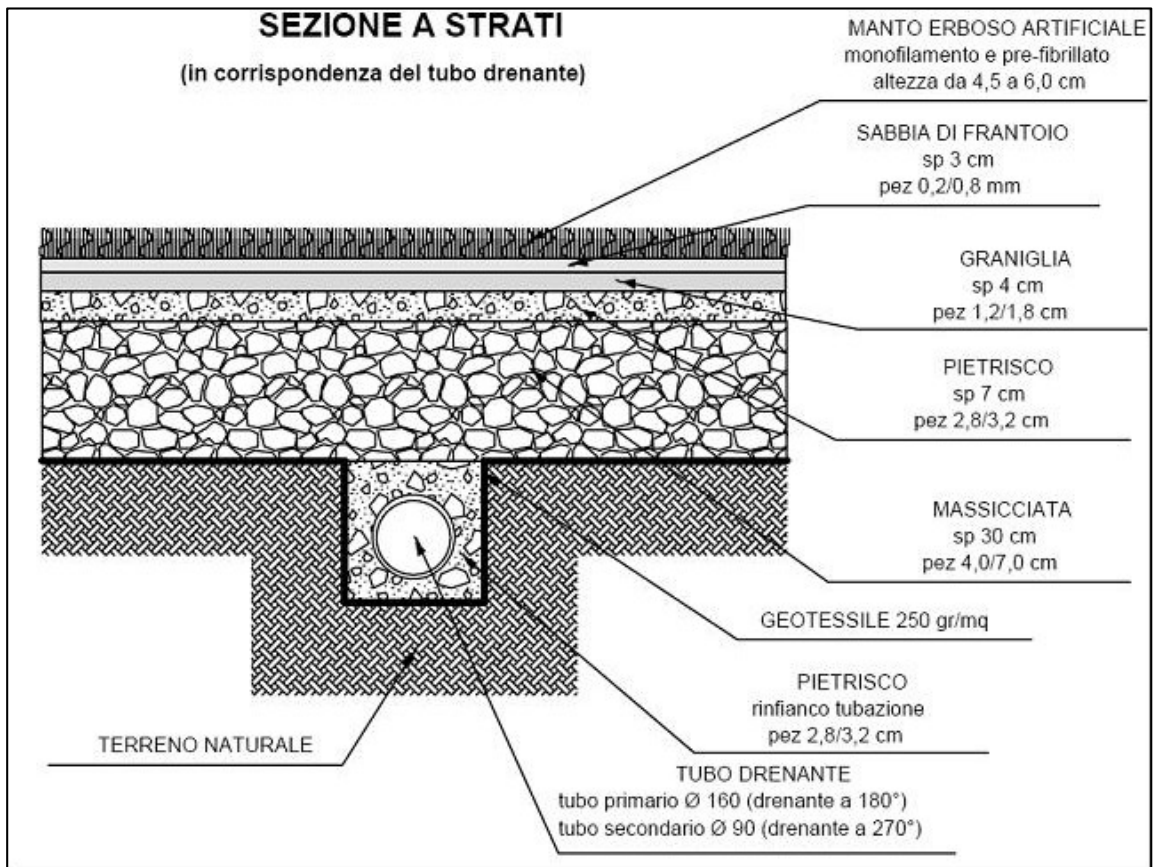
Sezione tipo a strati in corrispondenza di tubo drenante
